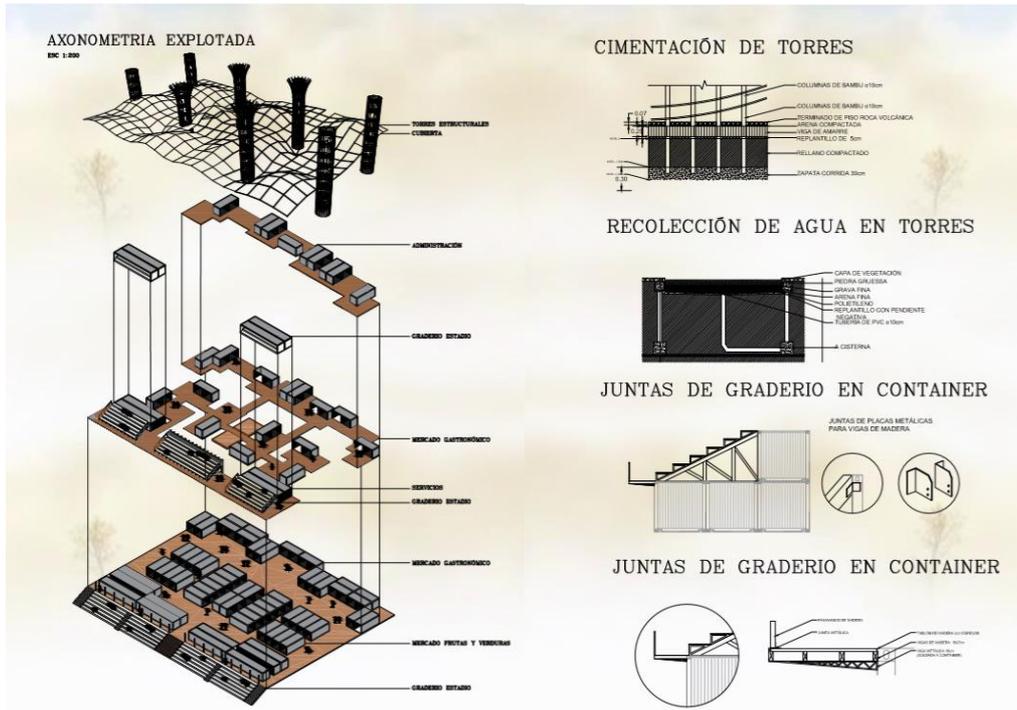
Axonometría explotada y detalles constructivos. Elaboración propia
